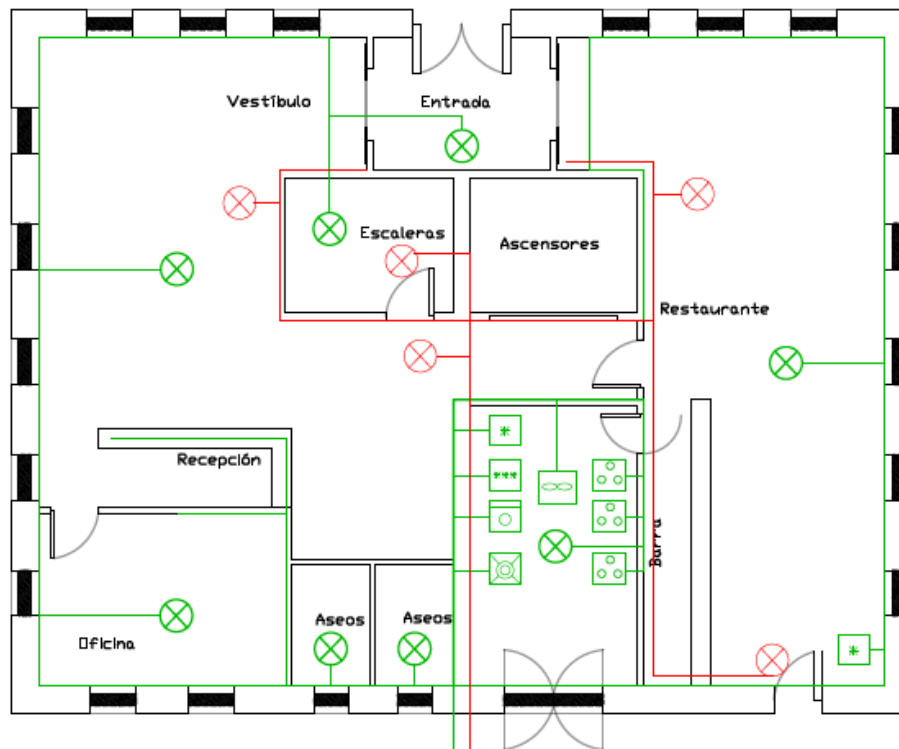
Plano del sistema eléctrico en la planta baja. Fuente: Elaboración propia
